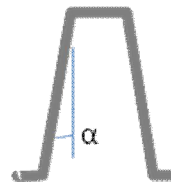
Vista en planta del ángulo de las paredes del vertedero con respecto al eje del vertedero.
